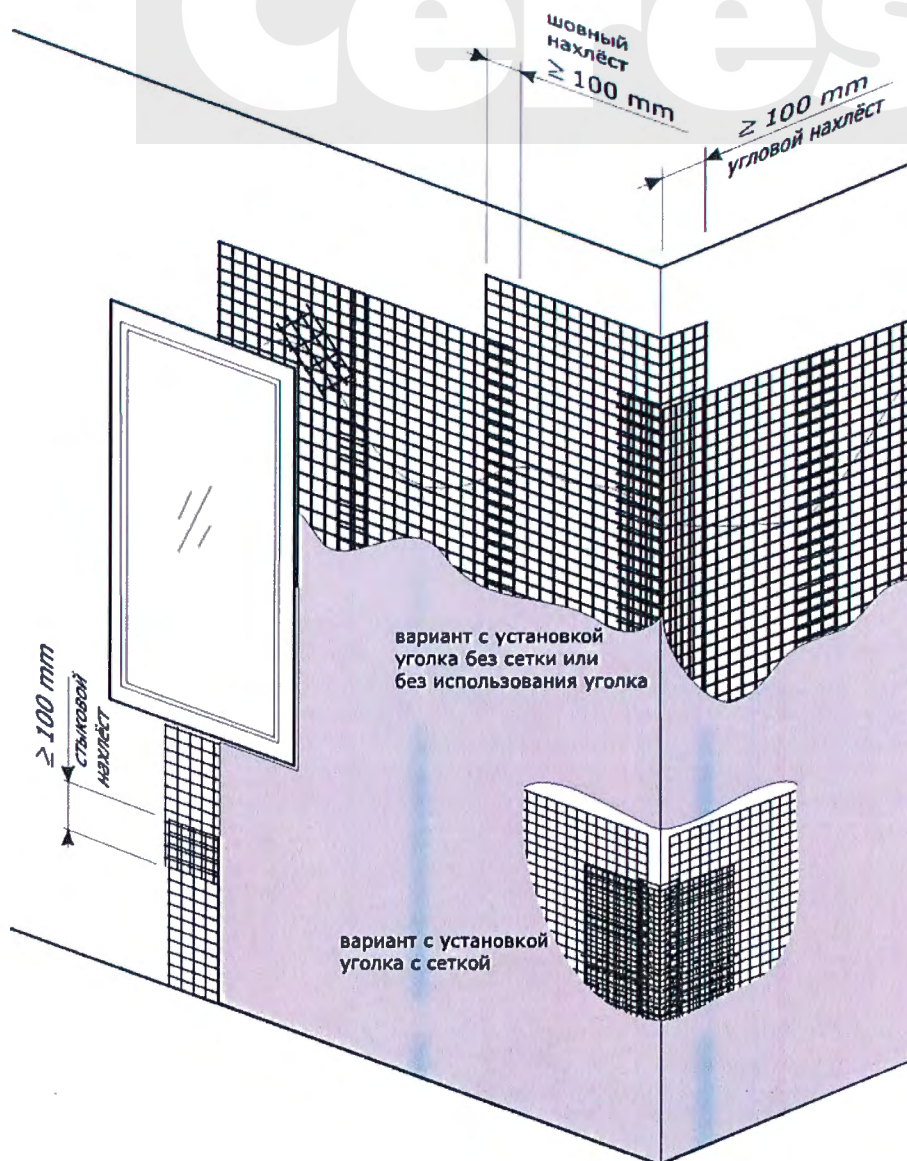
Армирование теплоизоляционных плит армирующей стеклосеткой
